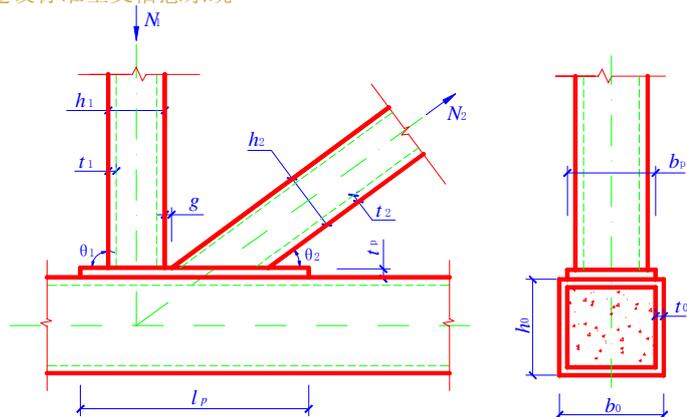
翼缘焊接钢板的节点加强措施
